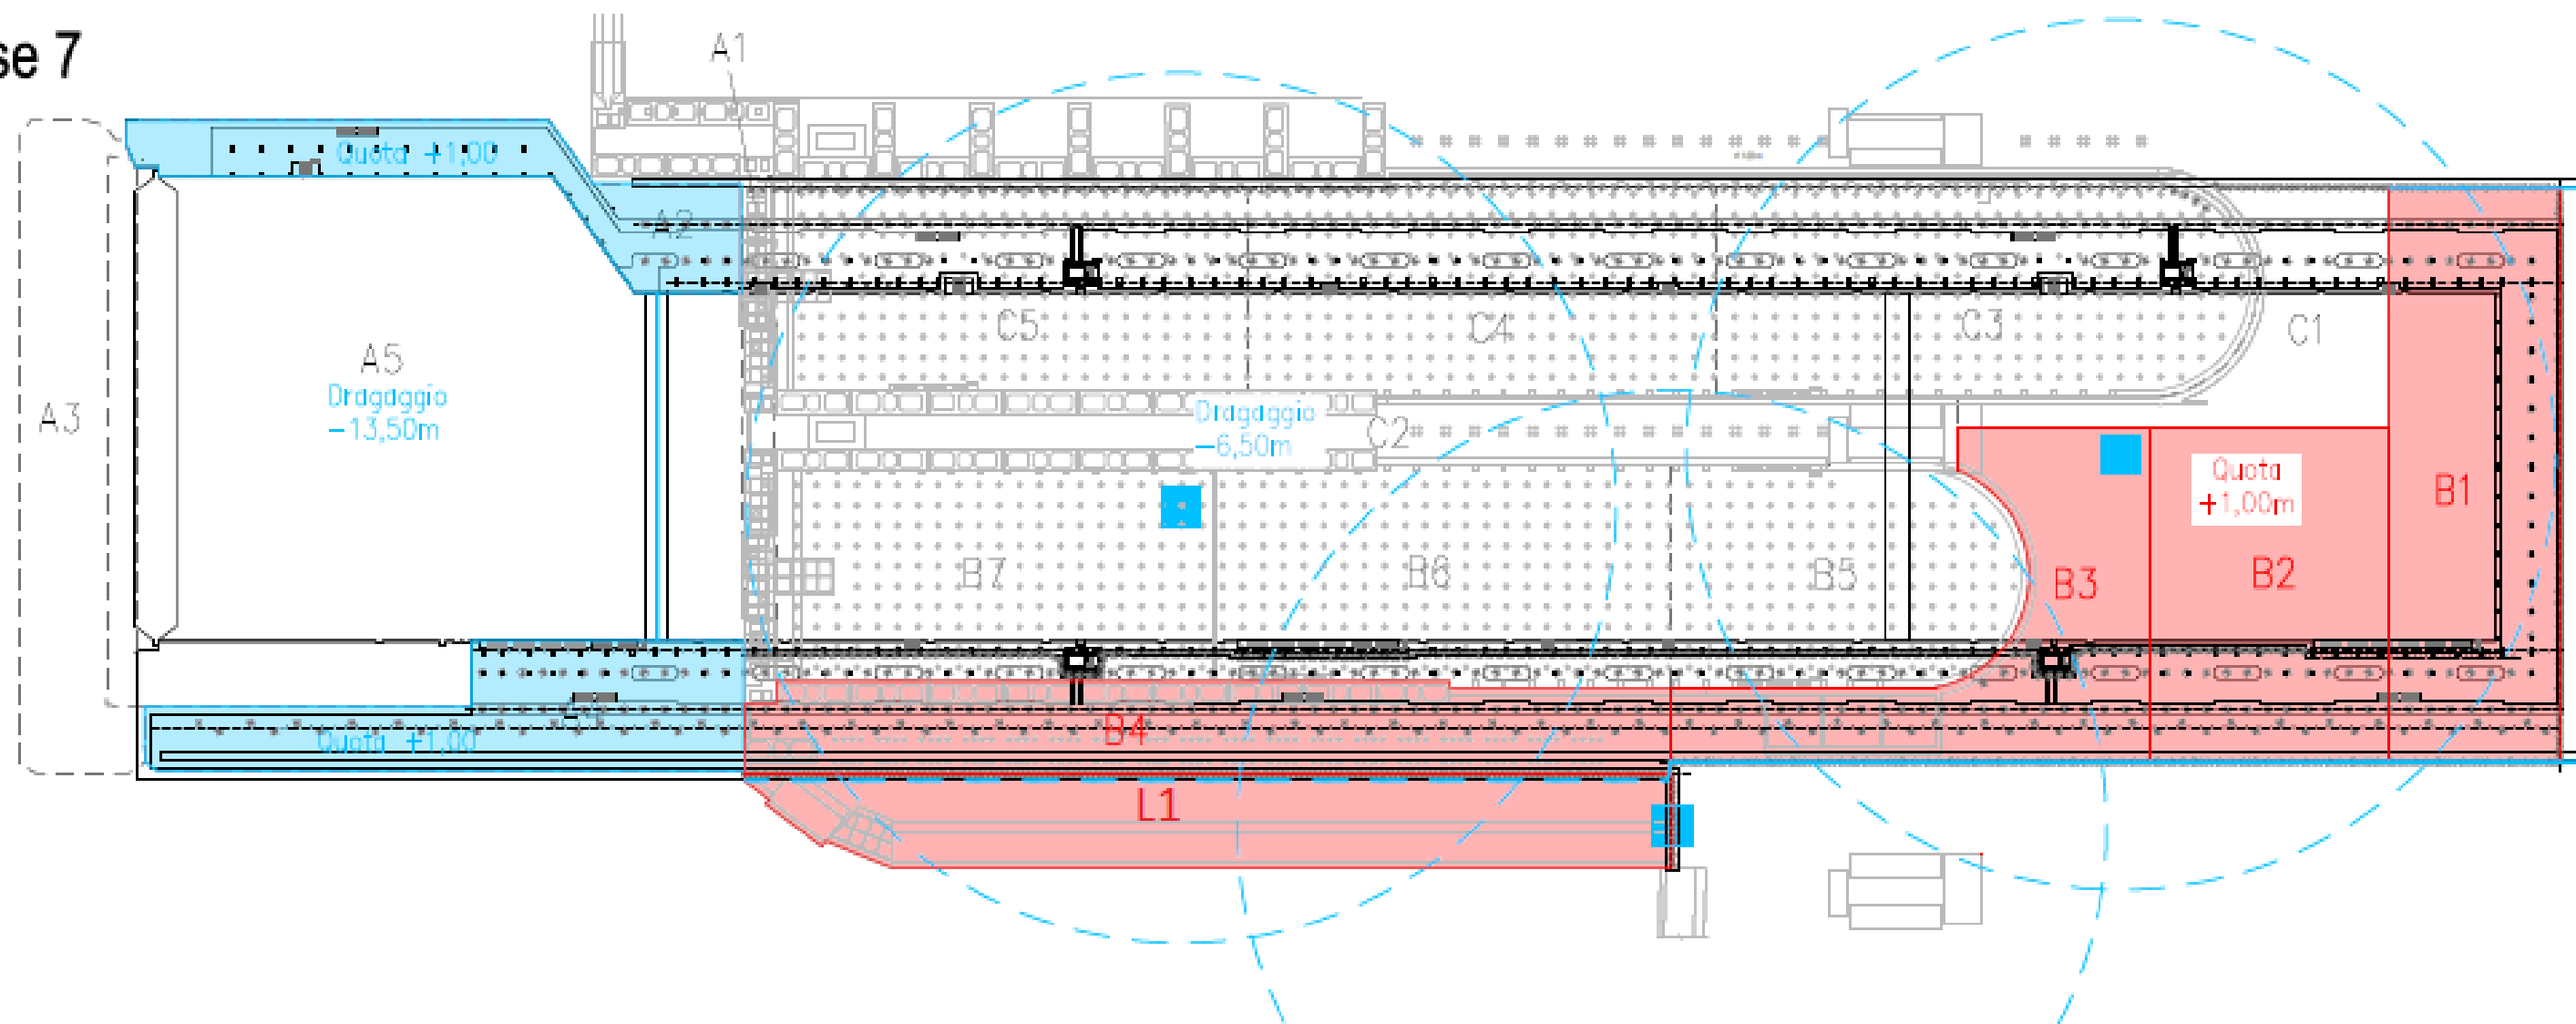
Planimetria dell'Opera C; In rosso le aree scavate fino alla + 1,0 m s.l.m.
